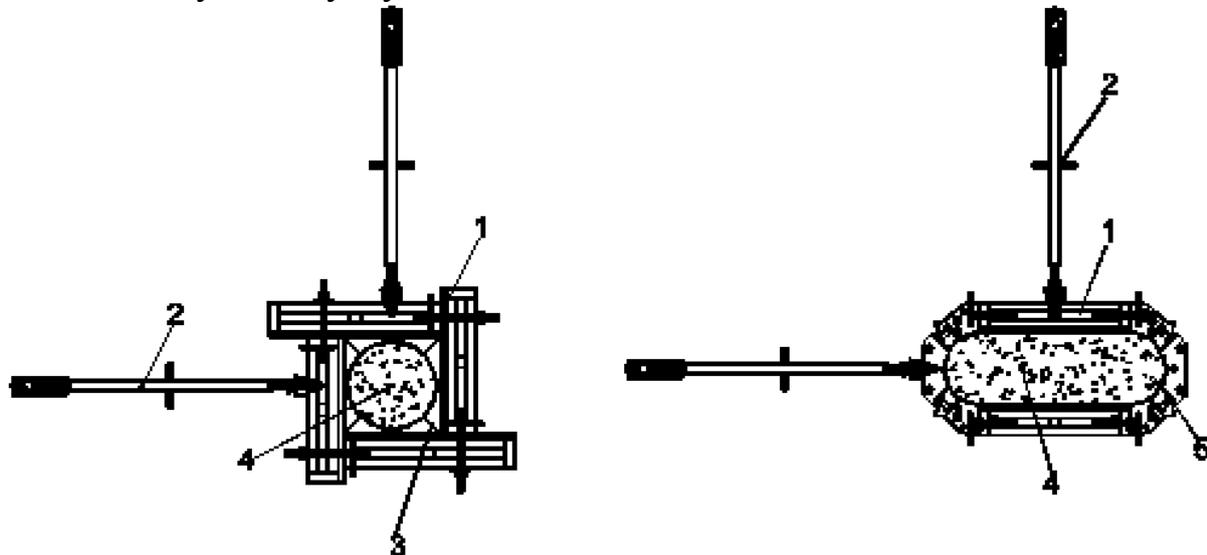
Схемы опалубливания круглых и овальных колонн
